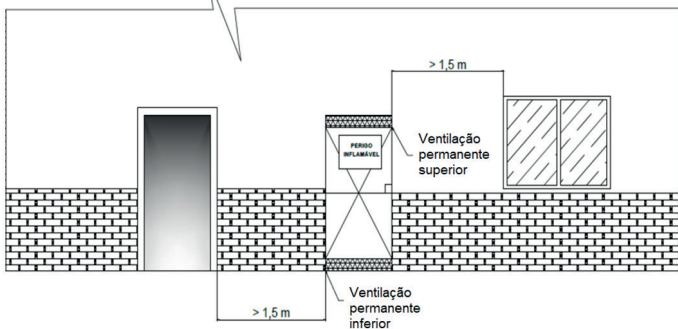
C – Planta baixa da central de GLP em nicho (informativo).
